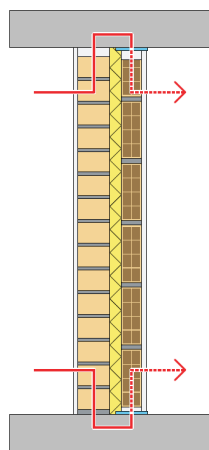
Pared separadora Silensis Tipo 2B: pared doble con bandas elásticas perimetrales en la hoja ligera. Interrupción del puente acústico estructural.
